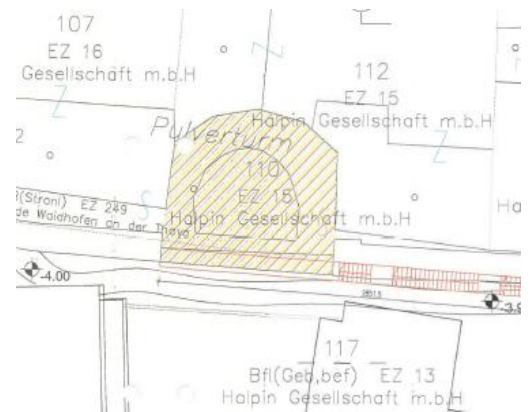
Plan Querschnitt Pulverturm (Gschwantner, 2017c)
